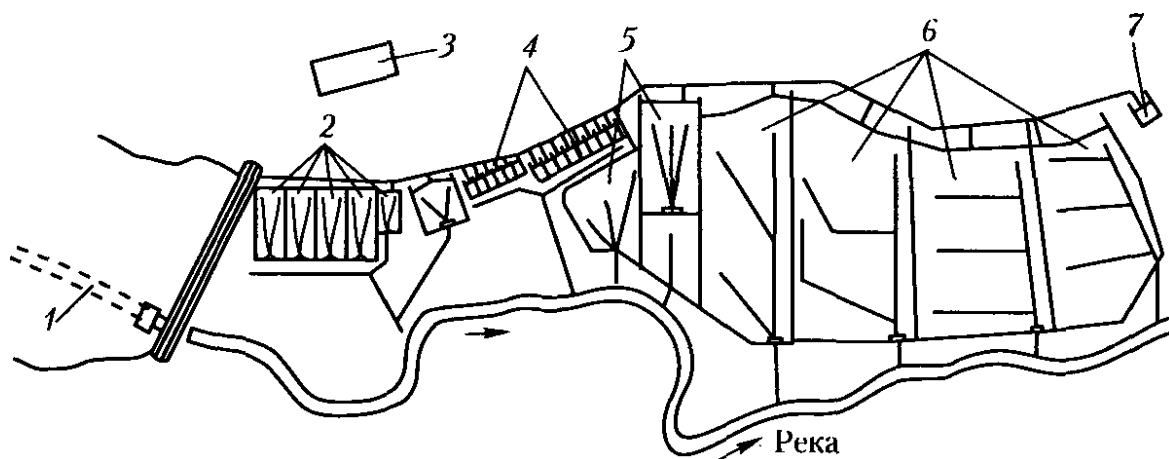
Схема рыбопитомника с самотечным водоснабжением из головного пруда:
